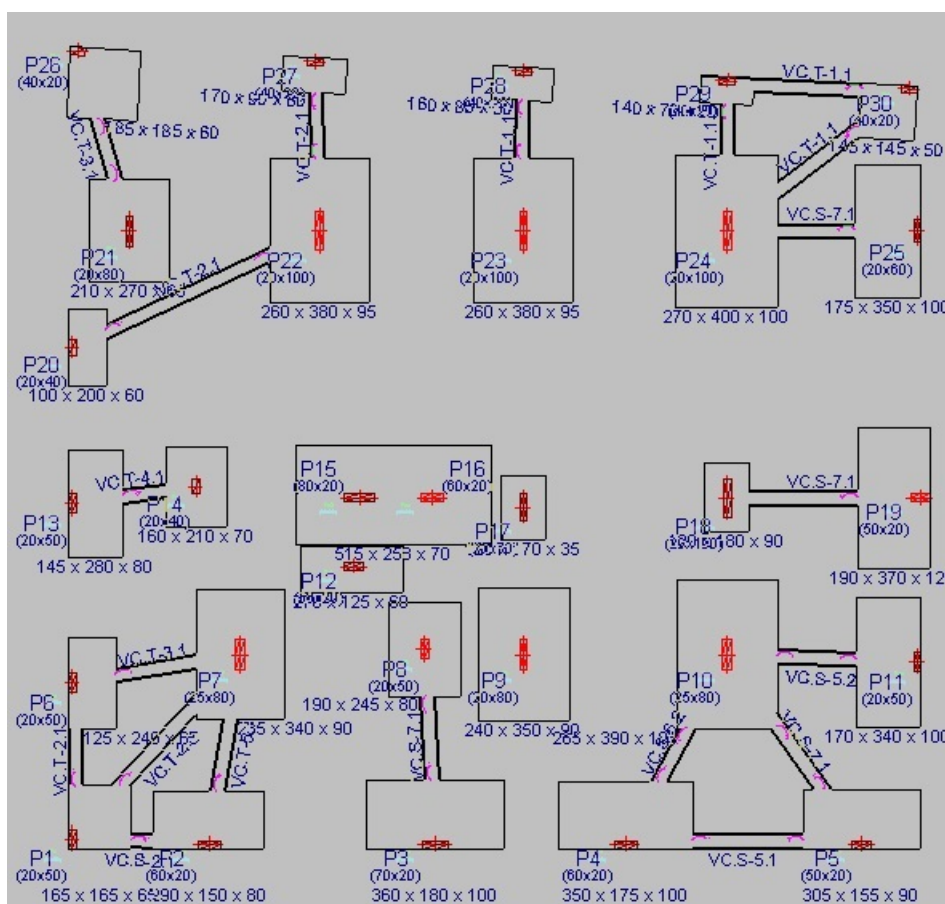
Locação das sapatas e das vigas de equilíbrio no Cypecad.
